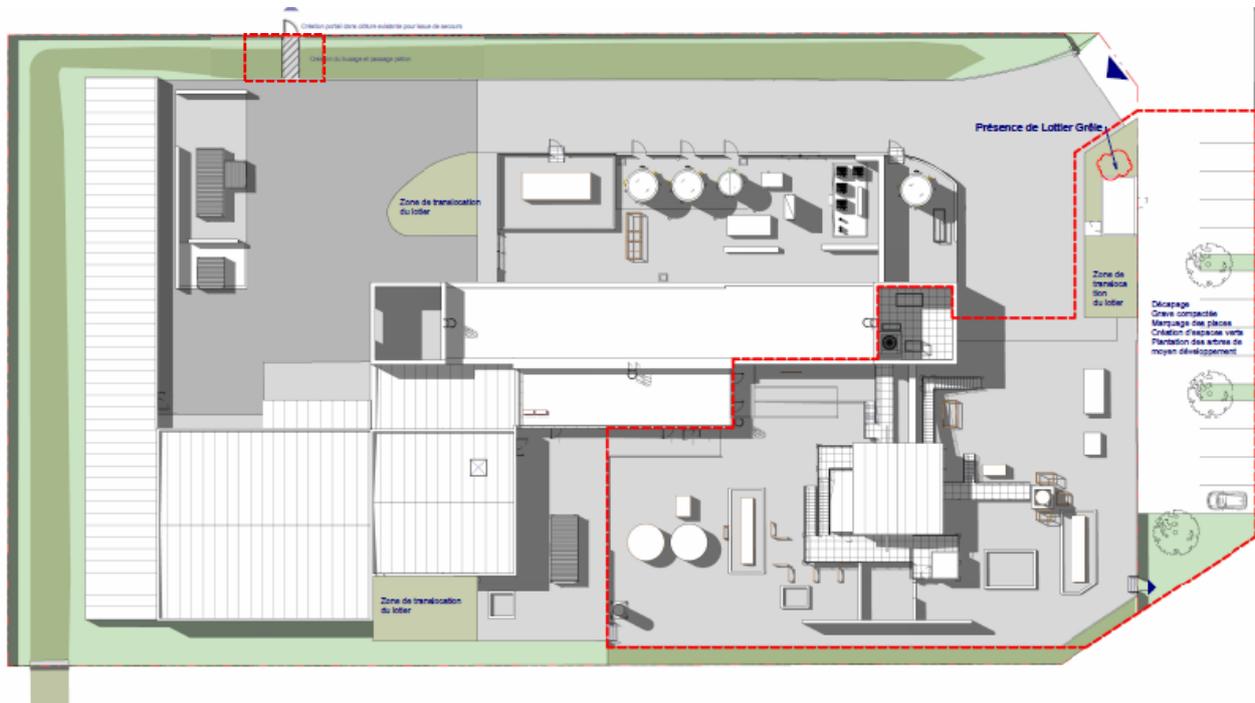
Plan du zonage des travaux de la 2^{ème} phase (source : TVA Architecte)
